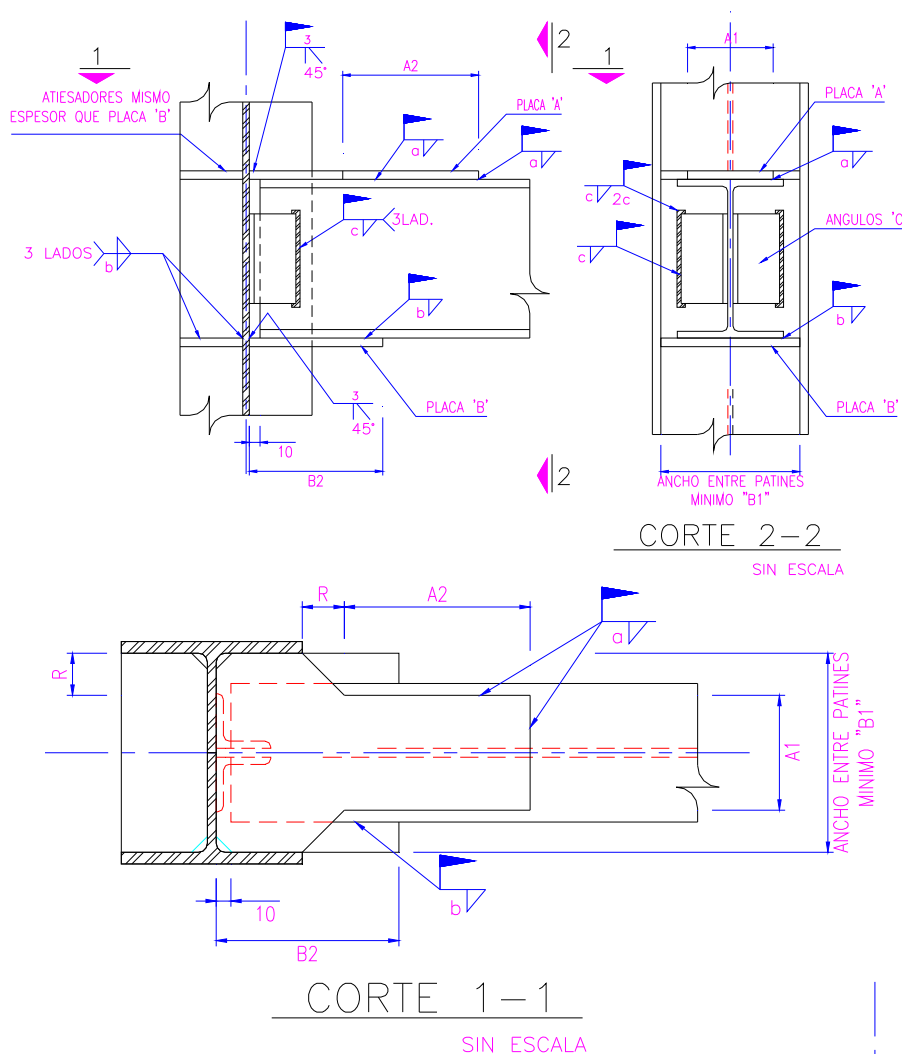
Detalles de la conexión a momento soldada a modelar
